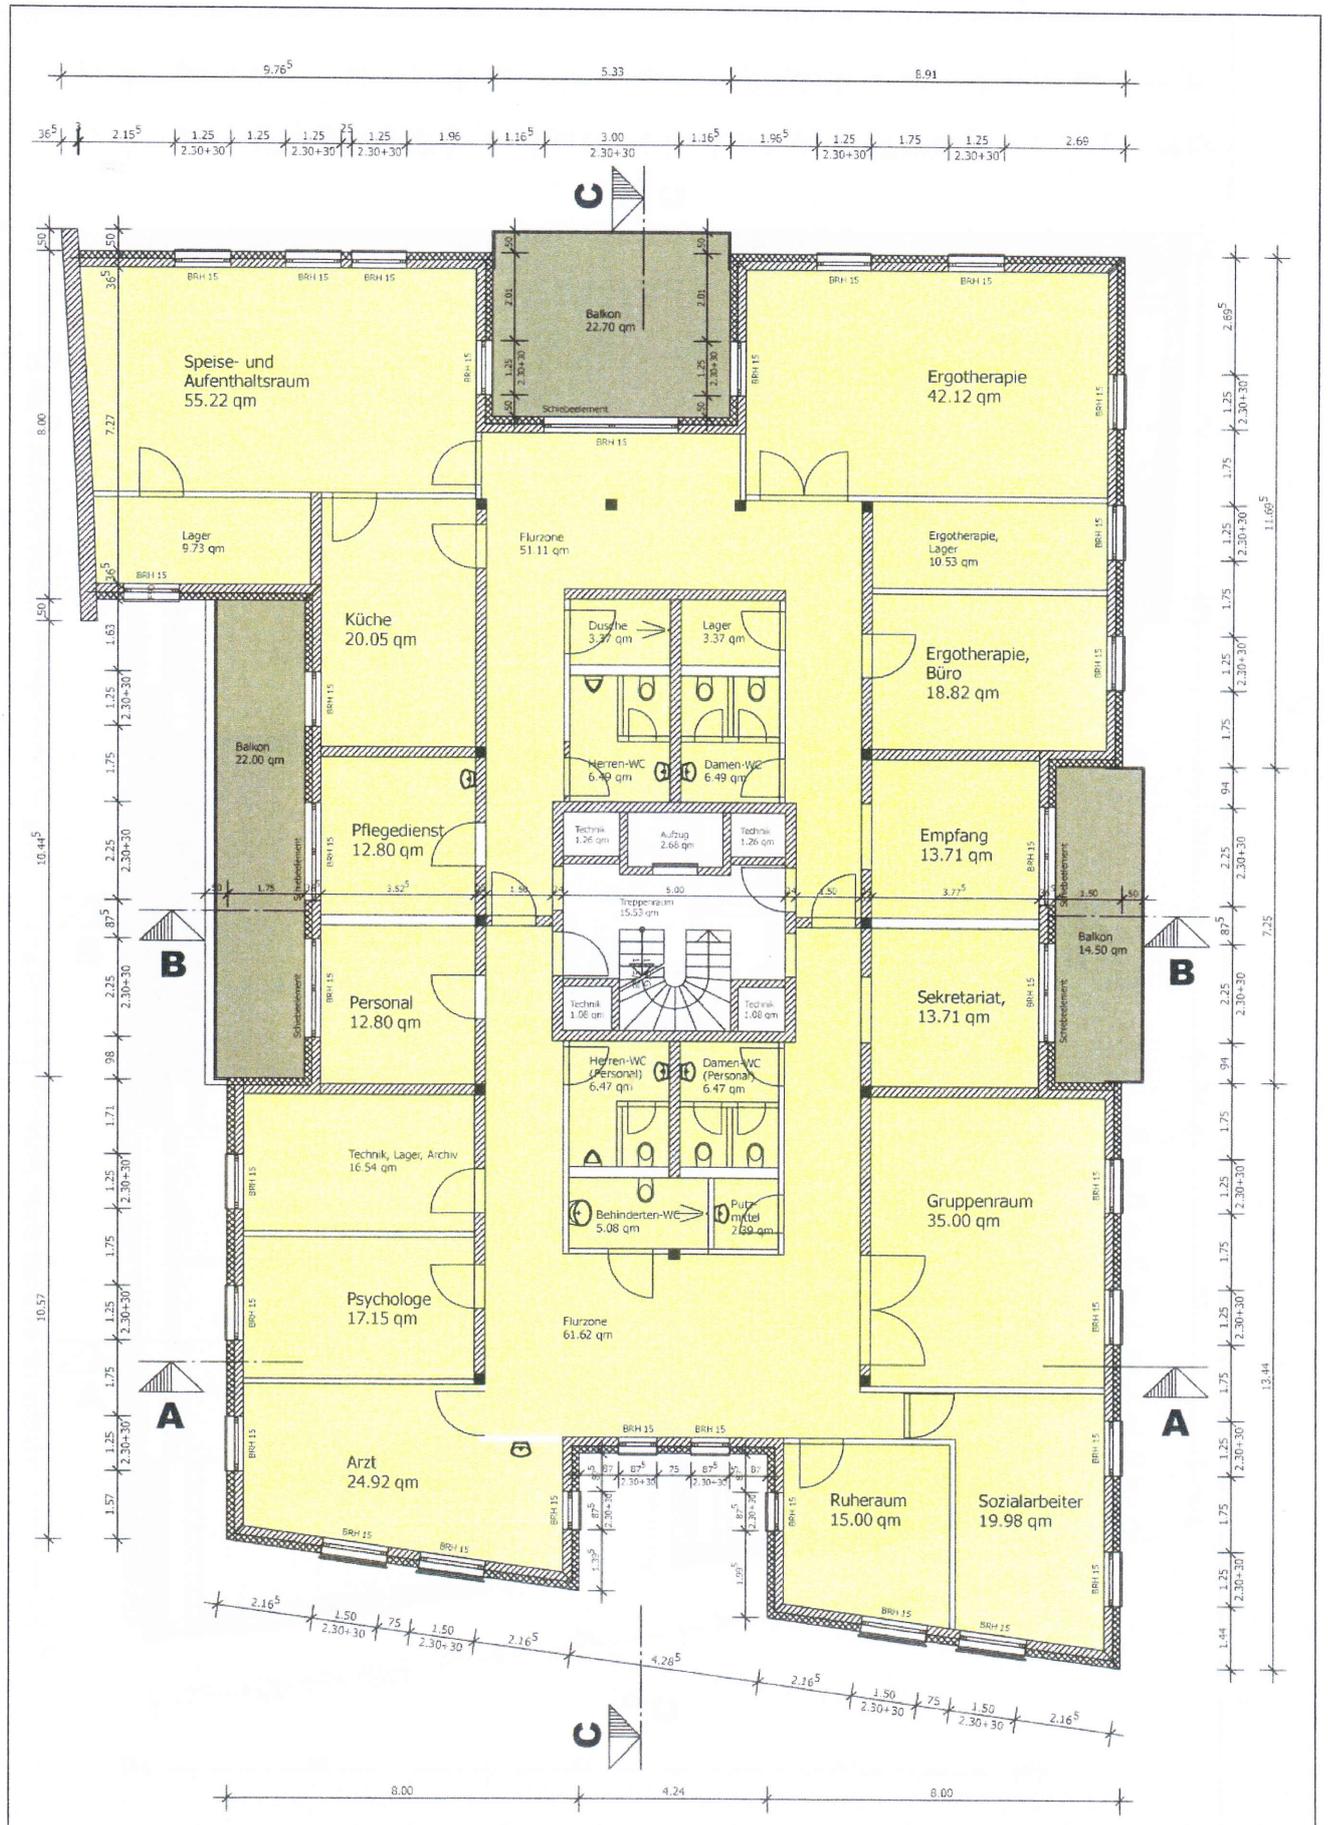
Grundriss Obergeschoss (o.M.)
